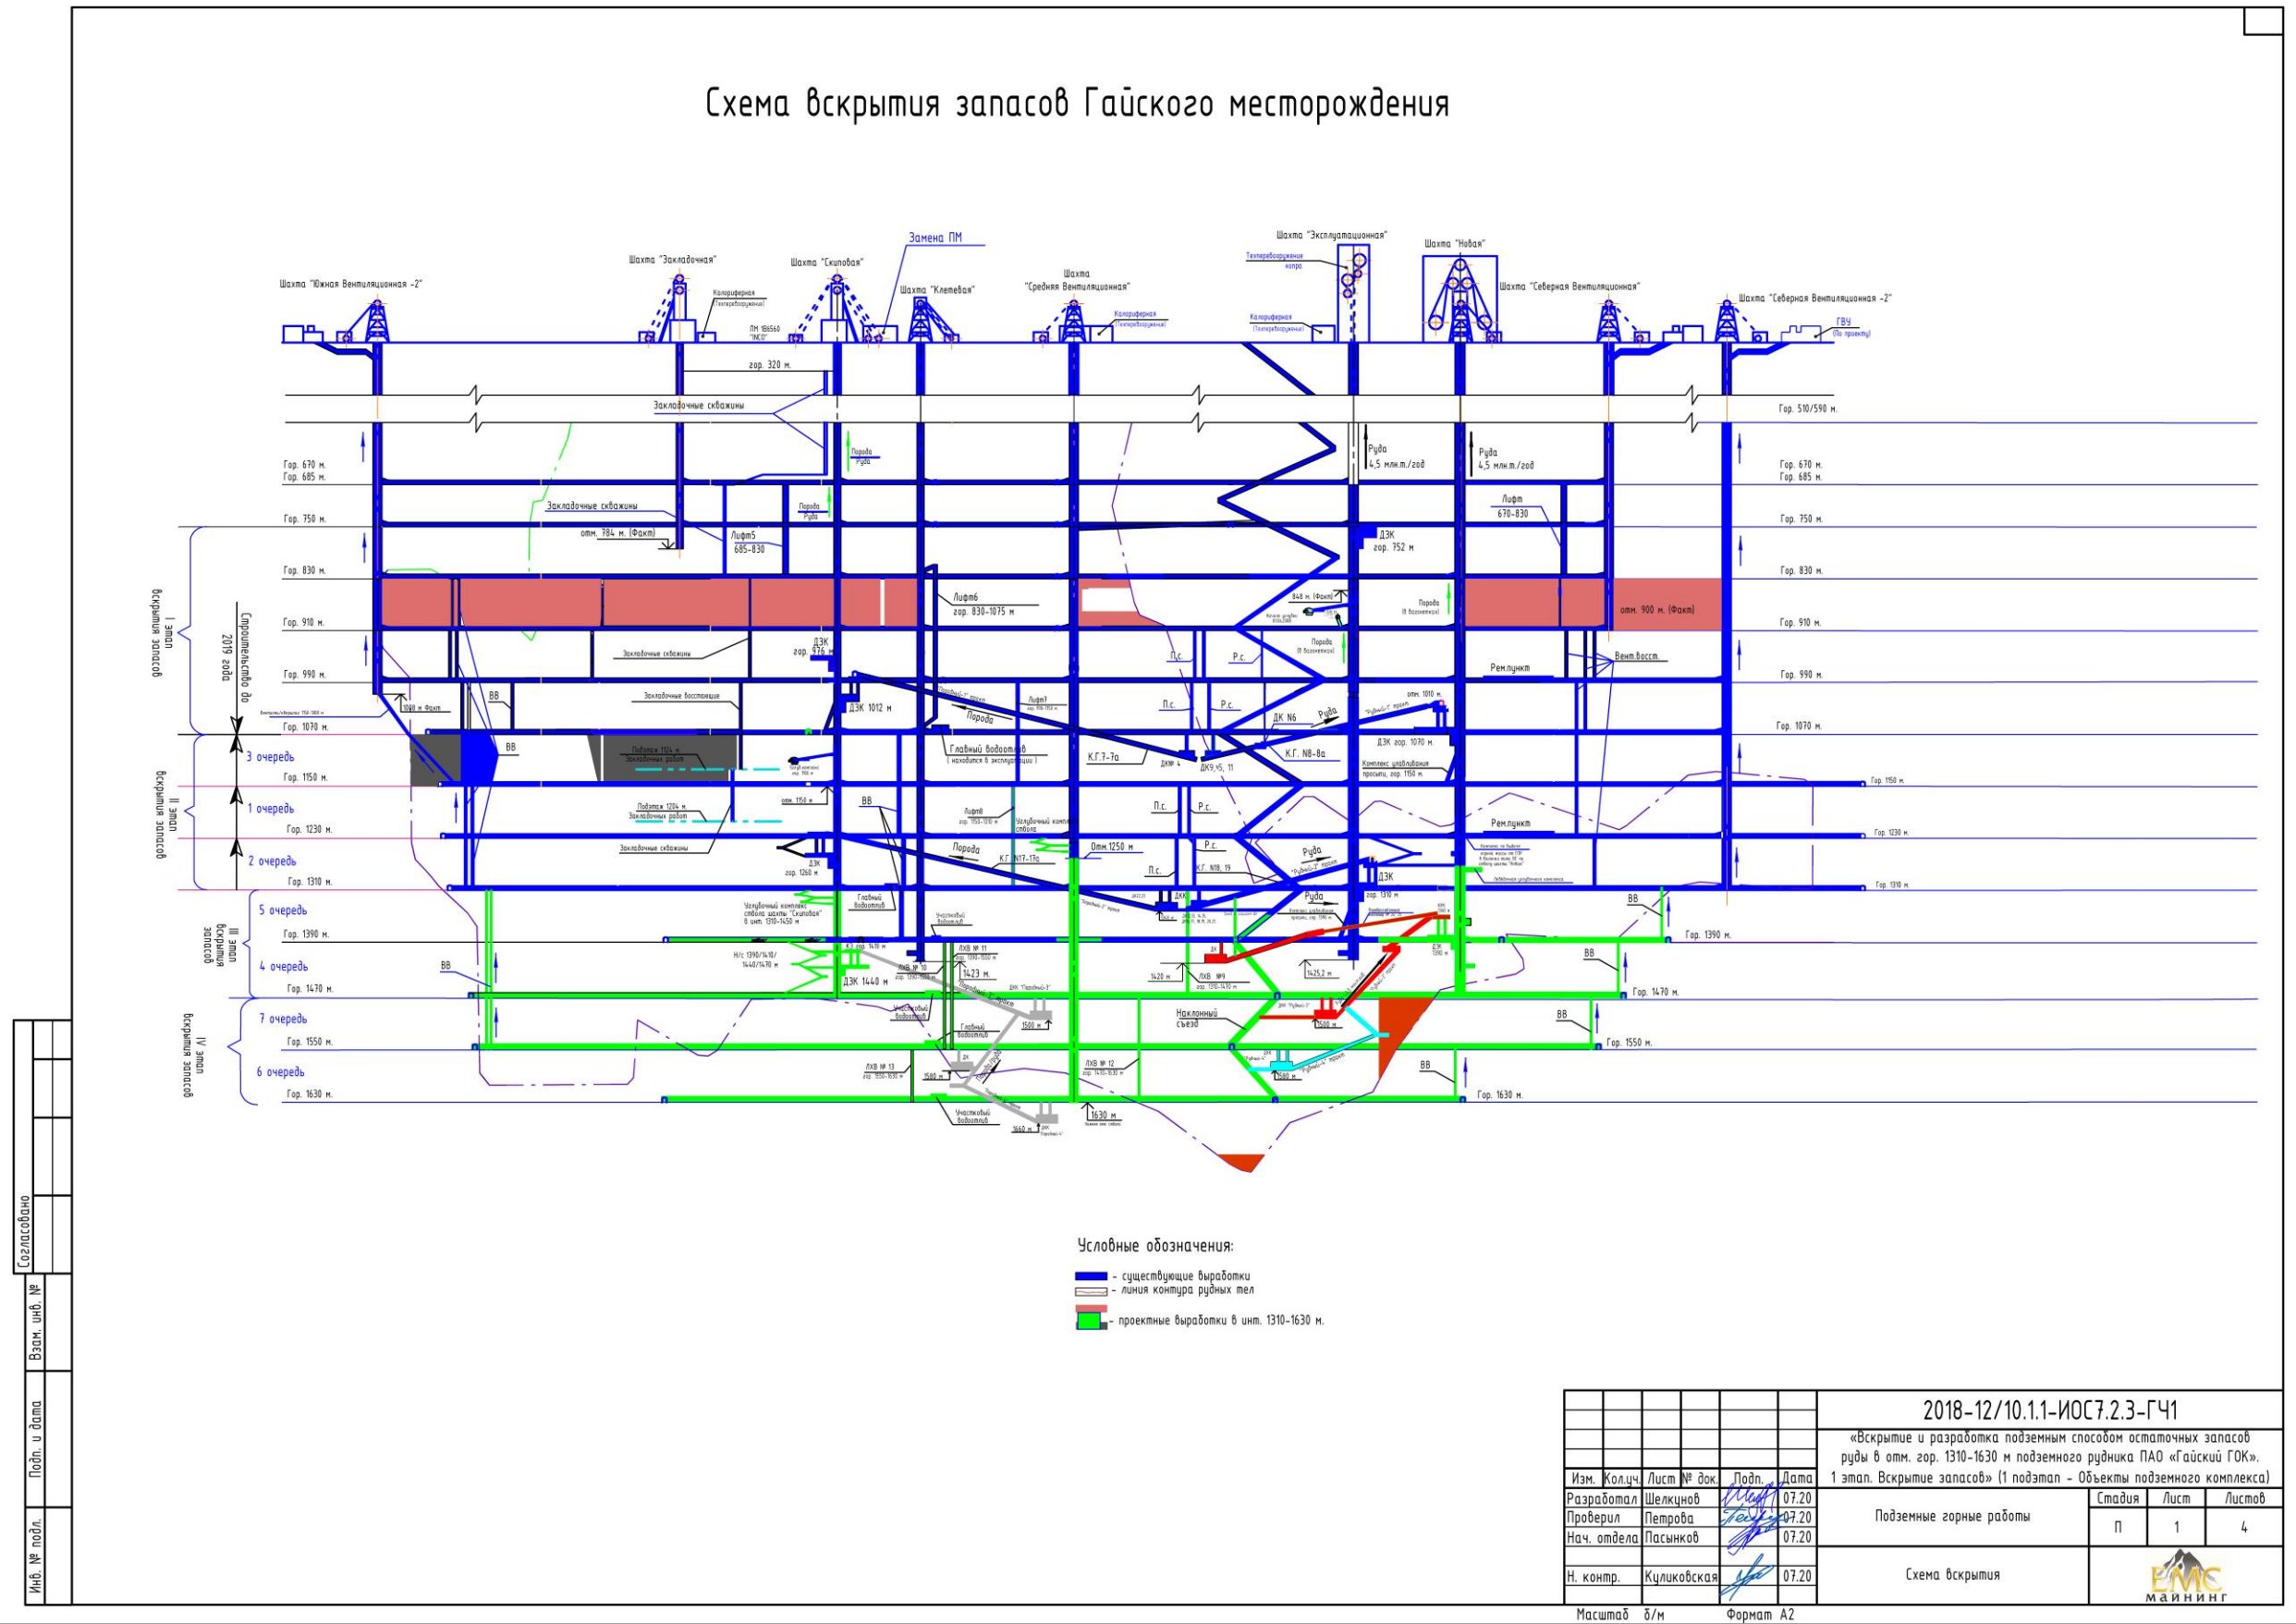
Схема вскрытия с учетом вскрывающих выработок 1 этапа
